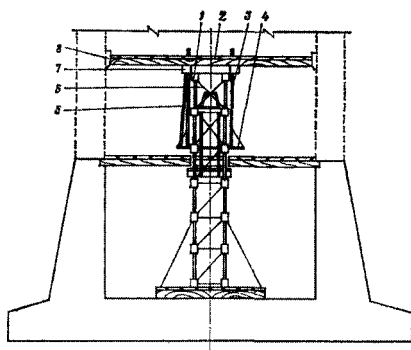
Монтаж нижней части подъемной головки и рабочей площадки:
